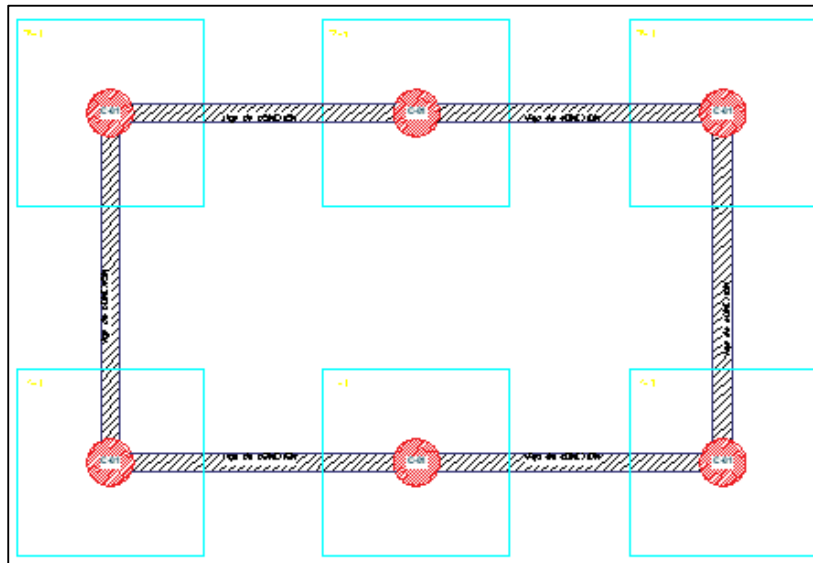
Vista en planta – Modulo II-.C del Instituto Pedagógico Publico Juana Moreno.
